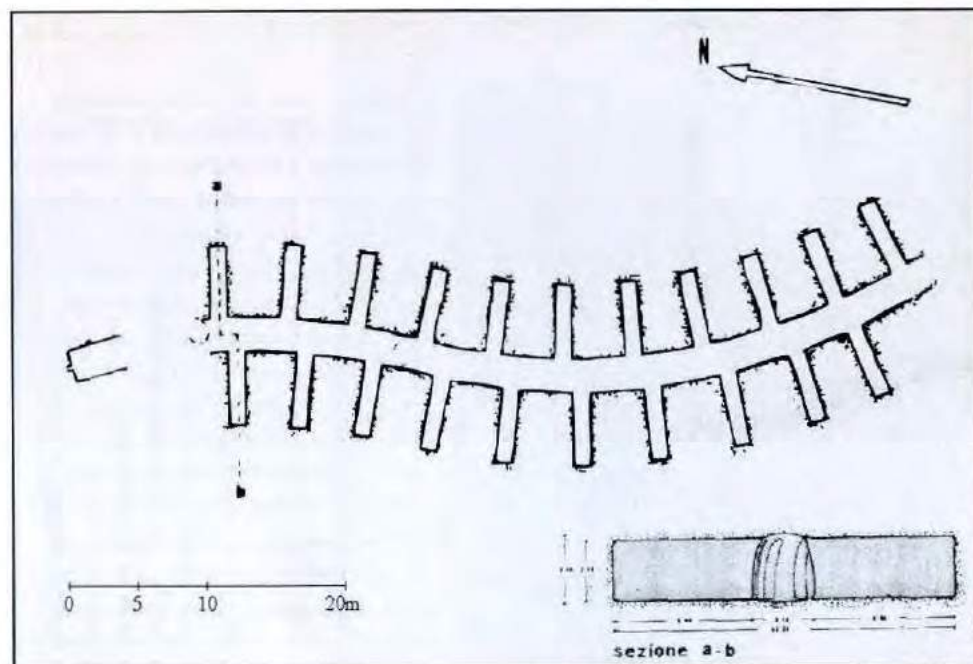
Pianta e sezione dei depositi di neve (Salza Prina Ricotti)
